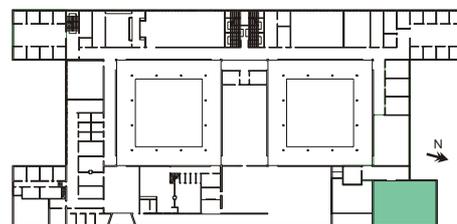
Localização da Sala Capitular na segunda versão de projeto. Primeiro pavimento. (Desenho da autora).
